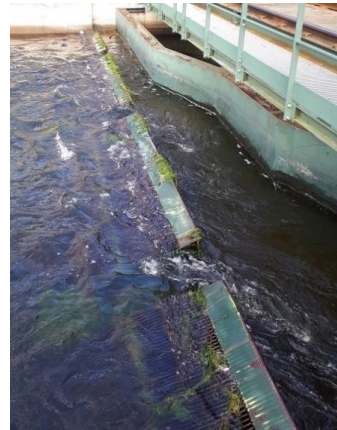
Plan de grille, exutoires et début du canal de transfert de Guilhot
